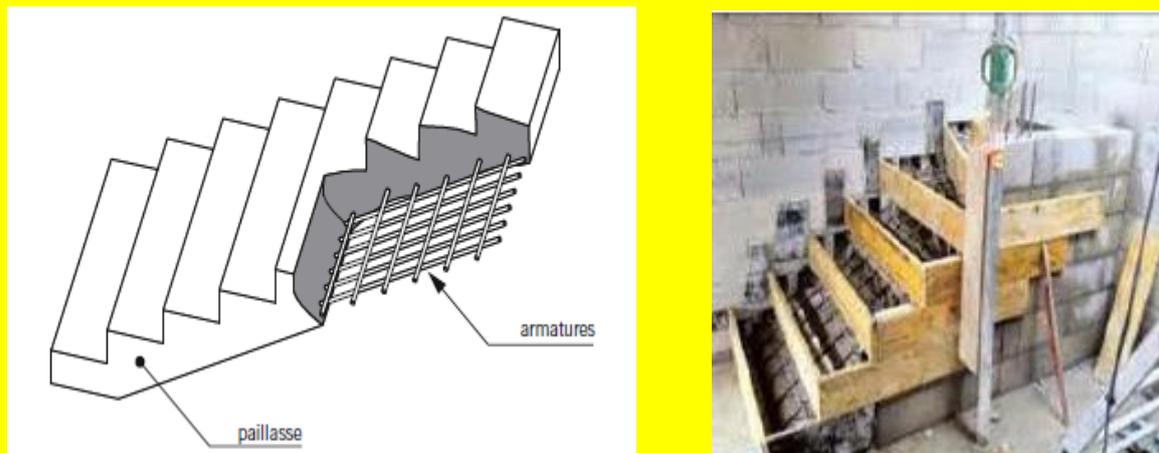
Escalier à l'anglaise escalier coulé en place
